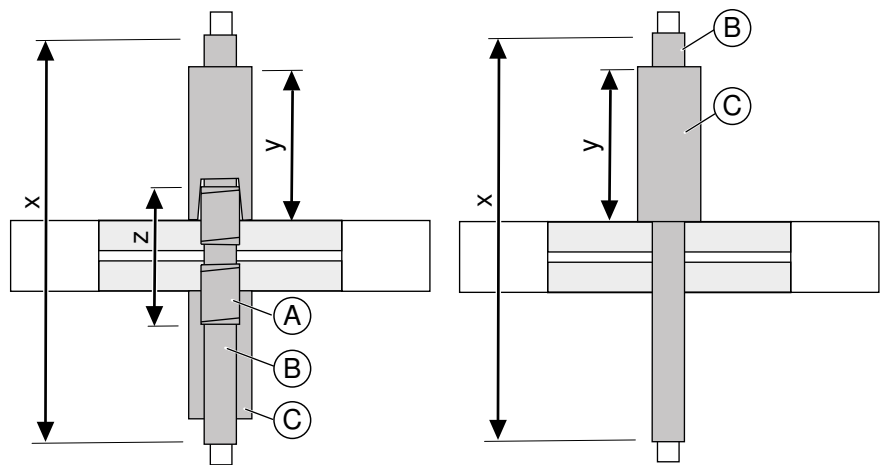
Strecken- und Schutzisolierung an nichtbrennbaren Rohren in Decken
